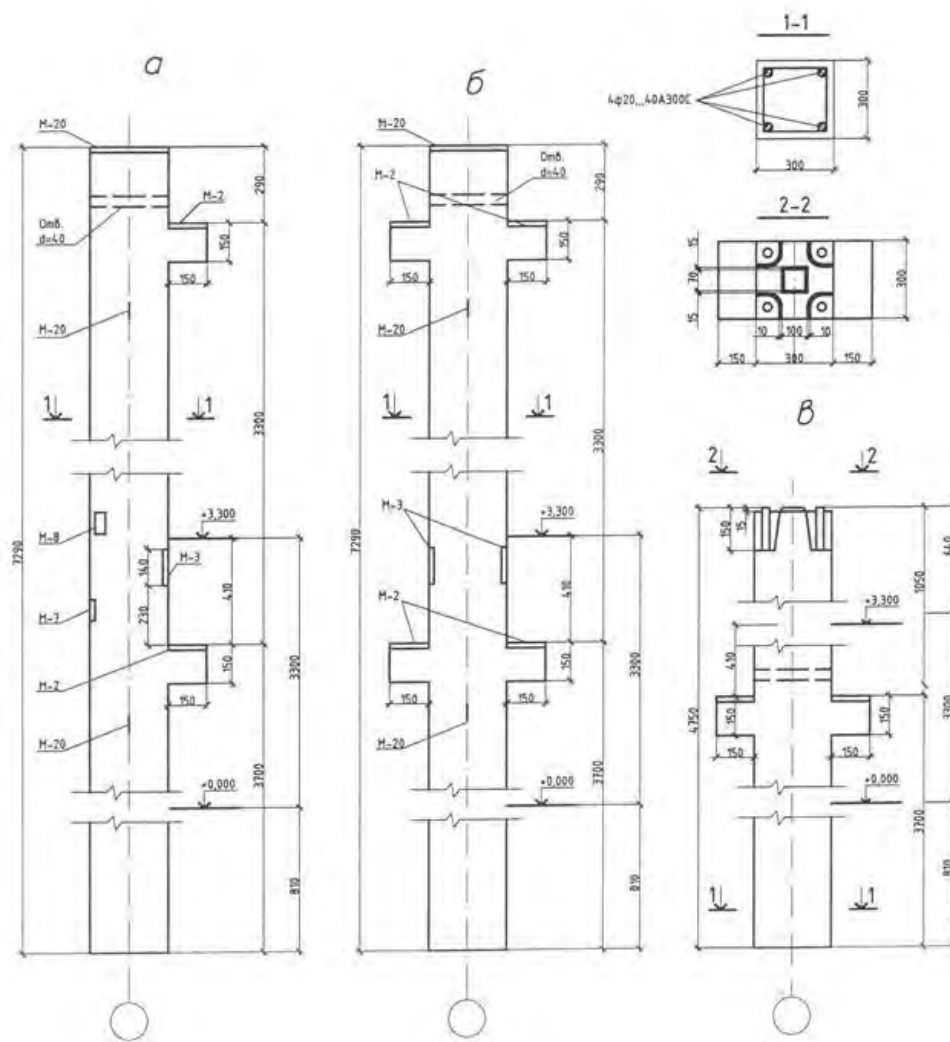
Збірні залізобетонні колони: а – верхня колона крайнього ряду; б – верхня колона внутрішнього ряду; в – середня колона внутрішнього ряду
